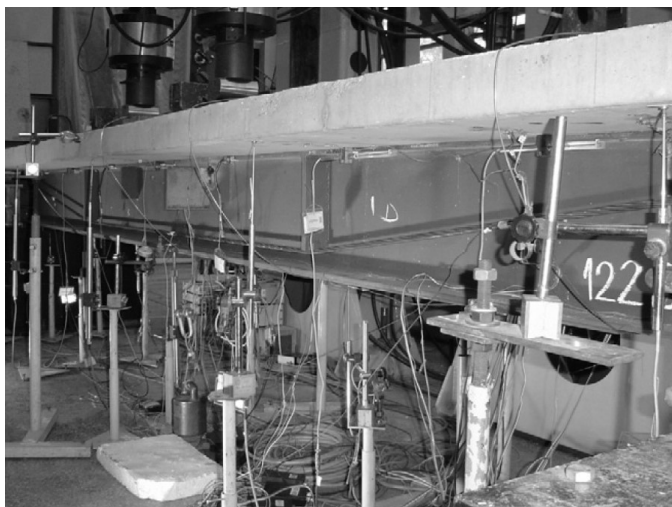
Geometria das vigas nos ensaios de Lorenc e Kubica (2006)
